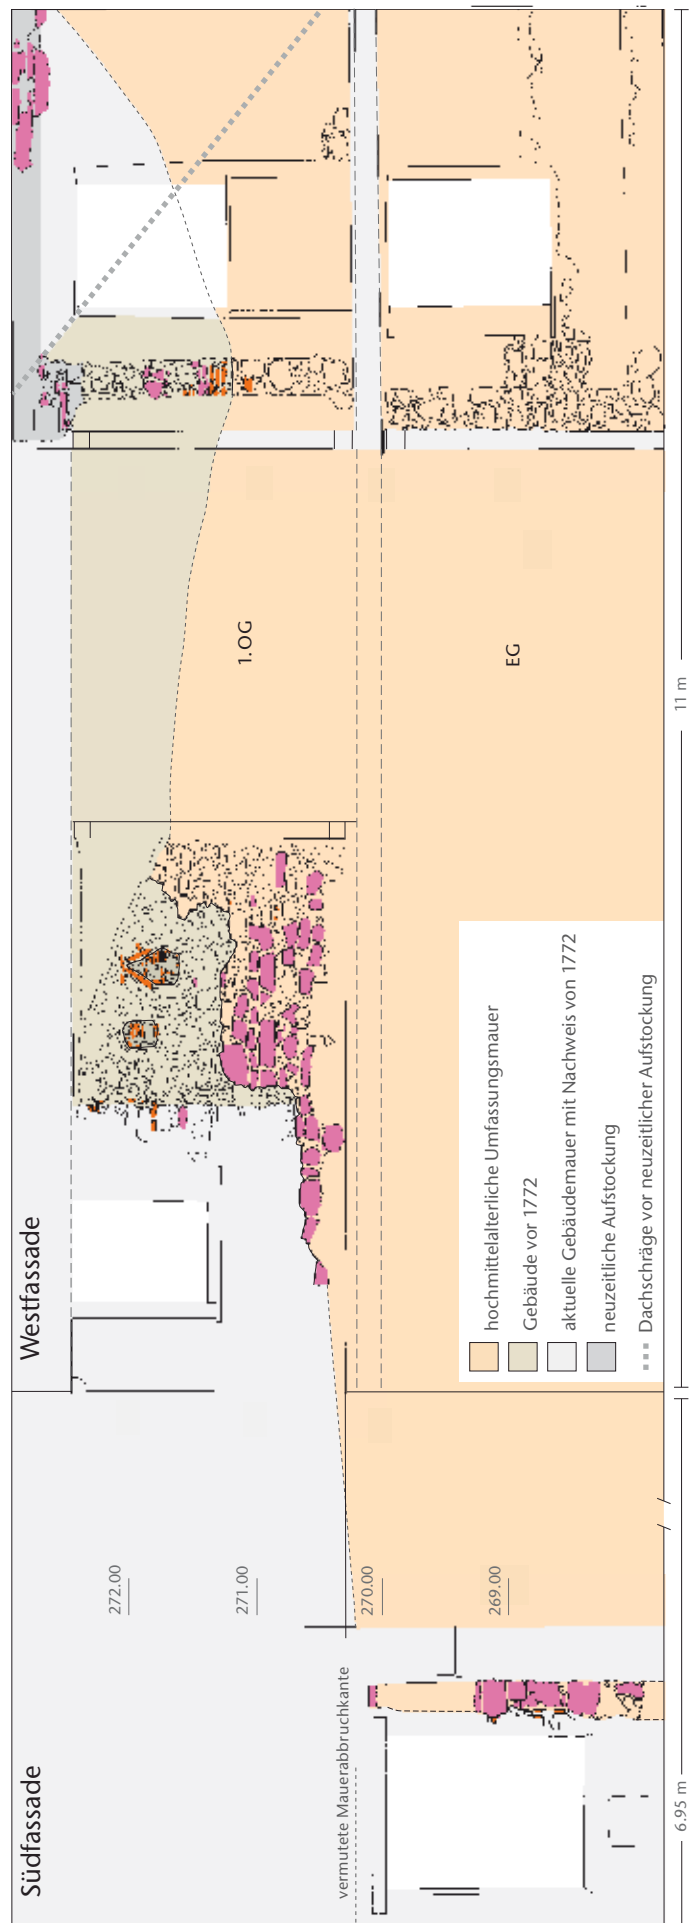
Kaiseraugst AG, Bauuntersuchung Kirchgasse (Grabung 2010.217). Westfassade Kirchgasse Haus 4, Stube 1. OG.
